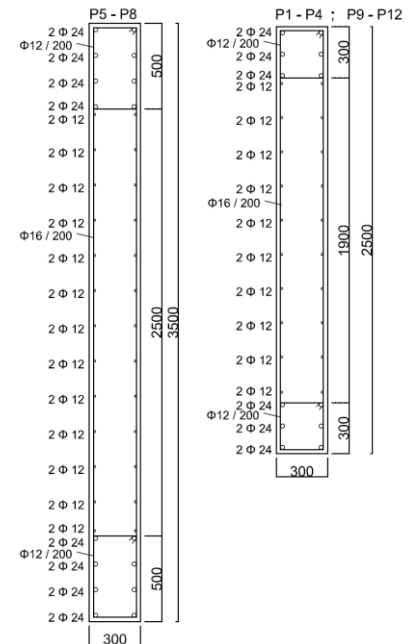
Kirişlere Ait Kesit ve Donatı Özellikleri
